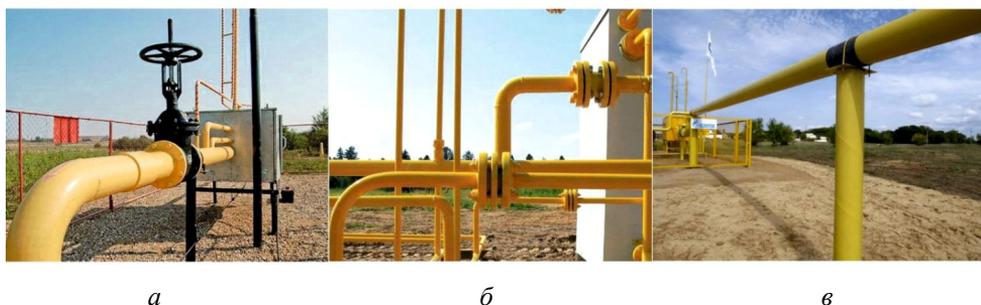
Наружный газопровод: *а* – шкафной газорегуляционный пункт; *б* – разводка наружных газопроводов; *в* – прокладка газопровода на высоких опорах
